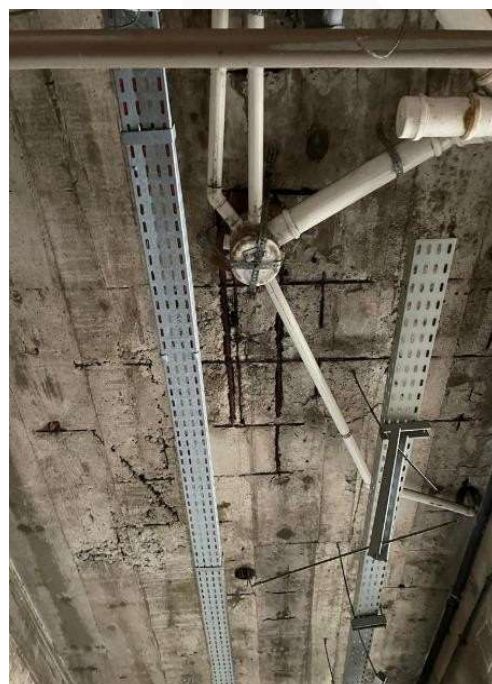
e Fig. 10 – Fissuração, falta de cobertura, armaduras em estado de oxidação, sinais de infiltração na laje.
